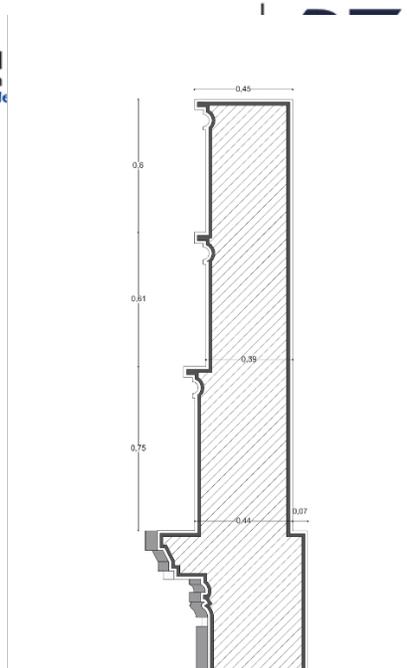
Sección A-A, detalle frontón, Estación del ferrocarril Sur.
